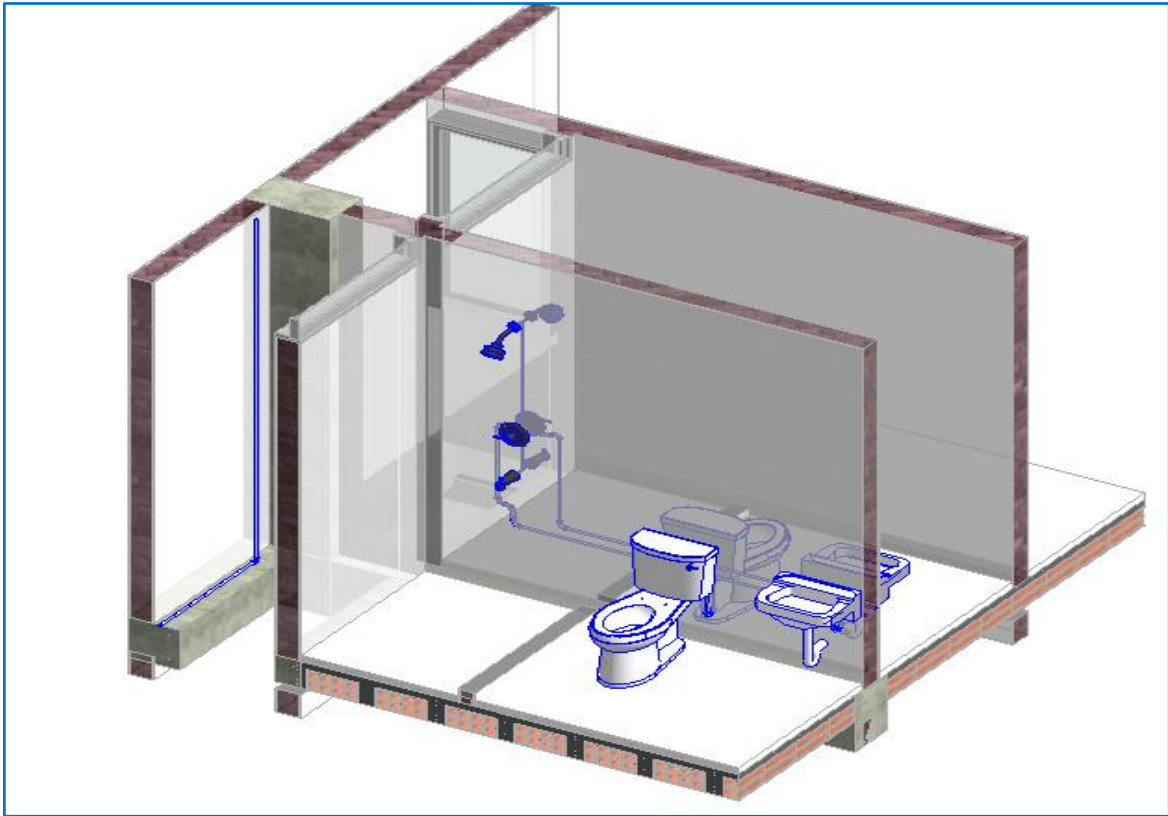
Vista 3D de corte de distribución de segundo nivel en Revit
